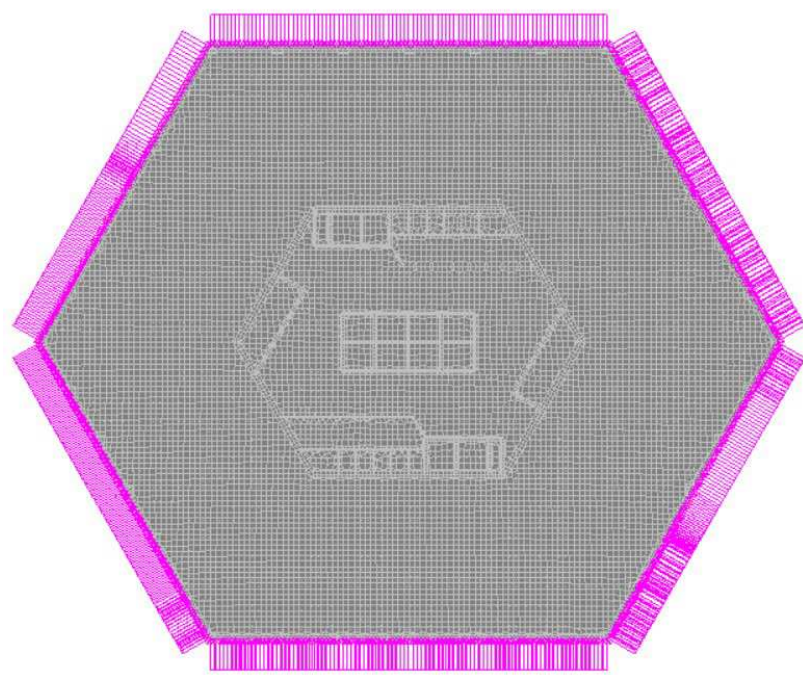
Схема приложения нагрузки от грунта на внешние стены
